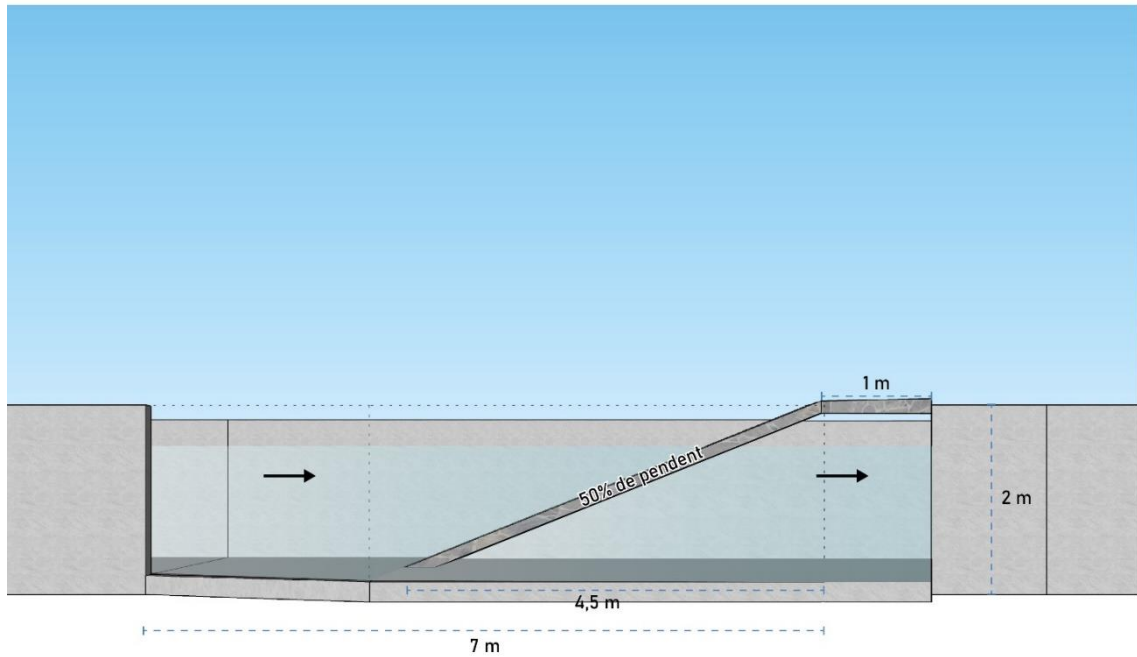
Rampa de salvament estructural annexada a la séquia primera del canal aplicant aquesta proposta.
